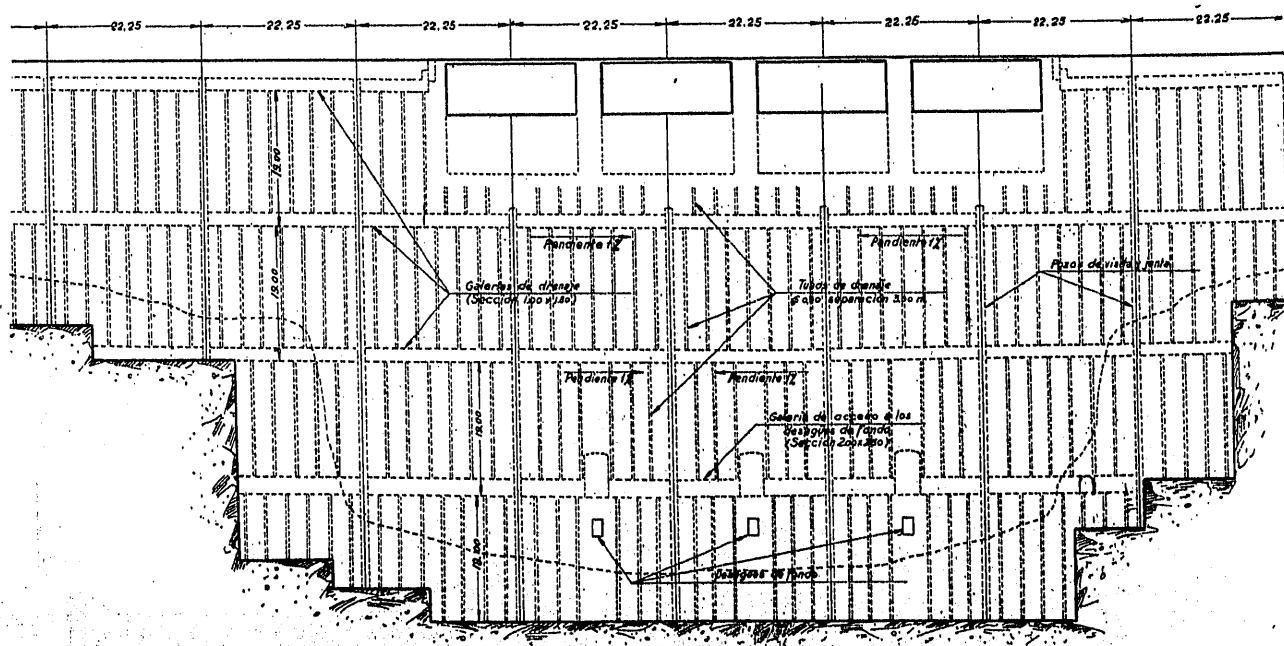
^a — Juntas de contracción y sistema de drenaje e inspección.
